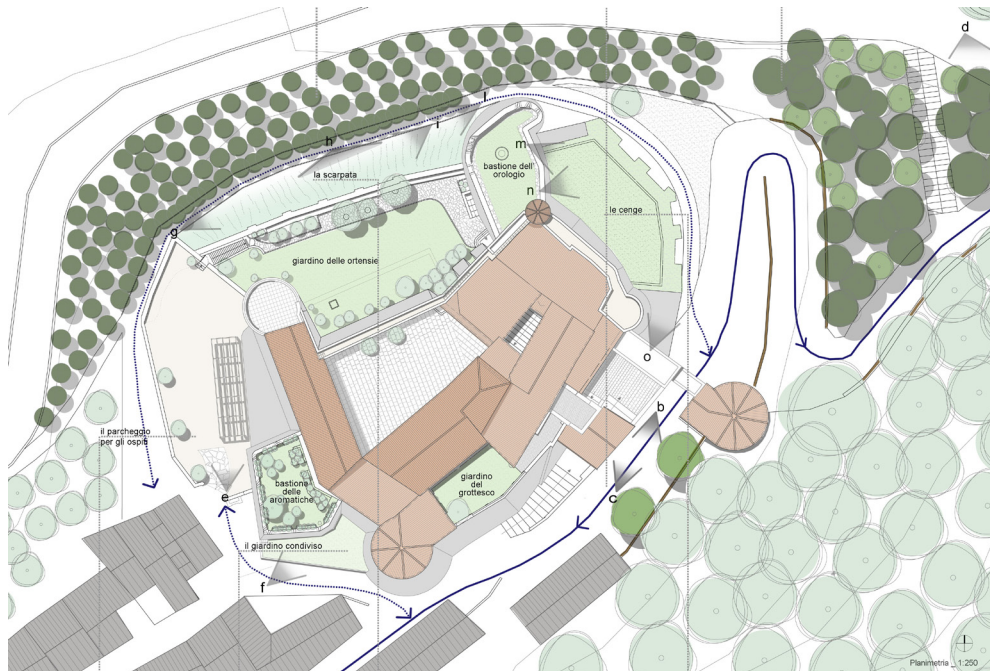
Planimetria del castello. Estratto dalle tavole di Tesi (tav.4)
